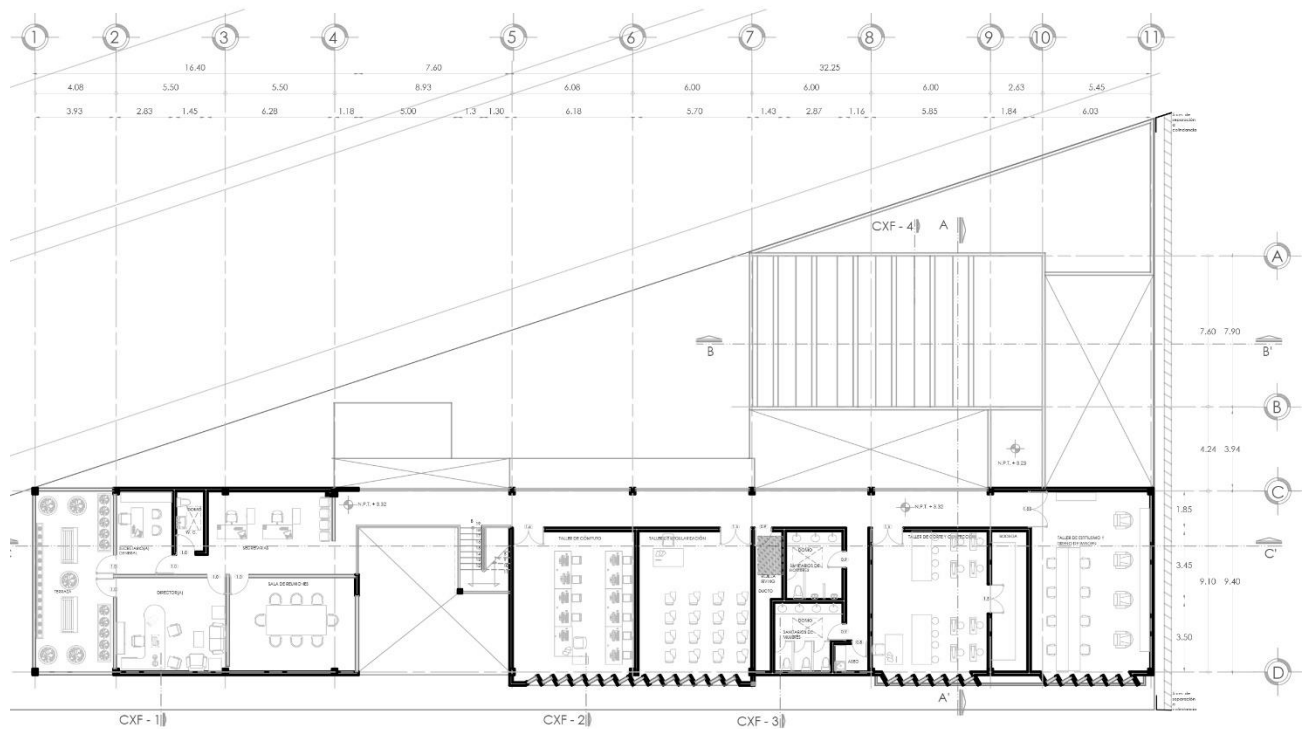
Plano de la planta alta, fuente: elaboración propia.
